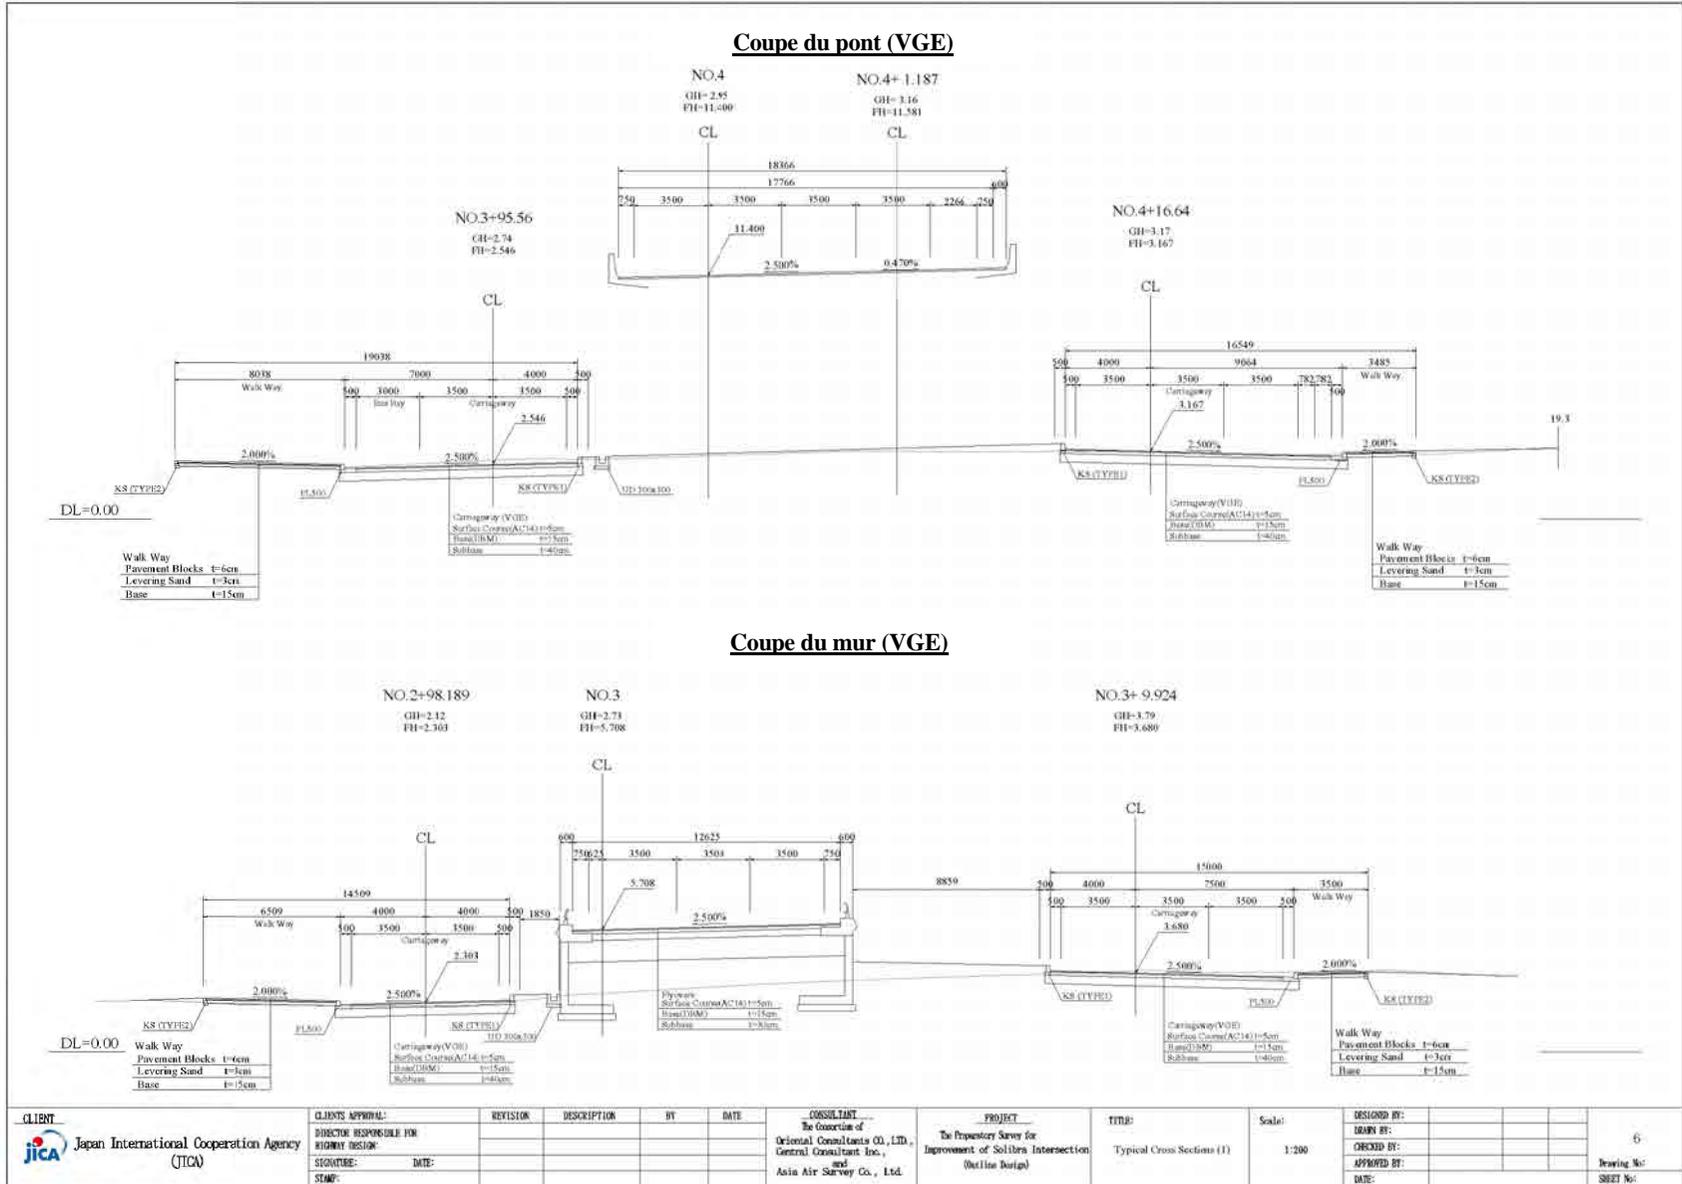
Coupe transversale type (VGE ; pont / mur de soutènement)
